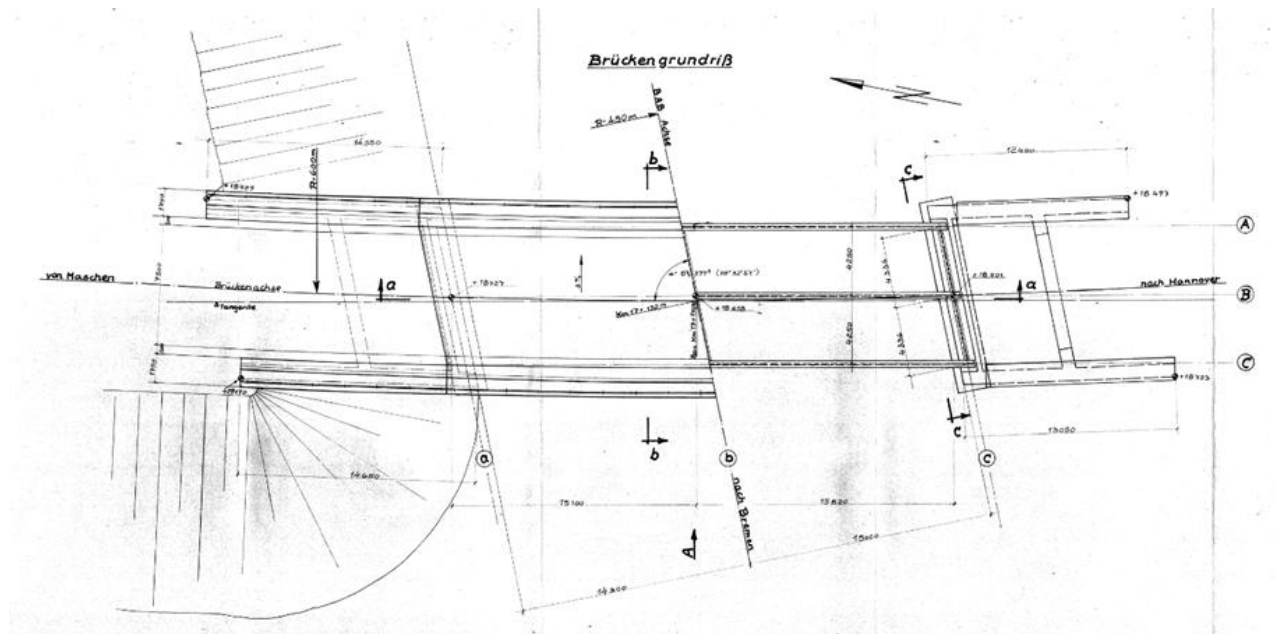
Brückengrundriß zu BW 434 (Auszug aus Bestandsplan zu BW 434)
